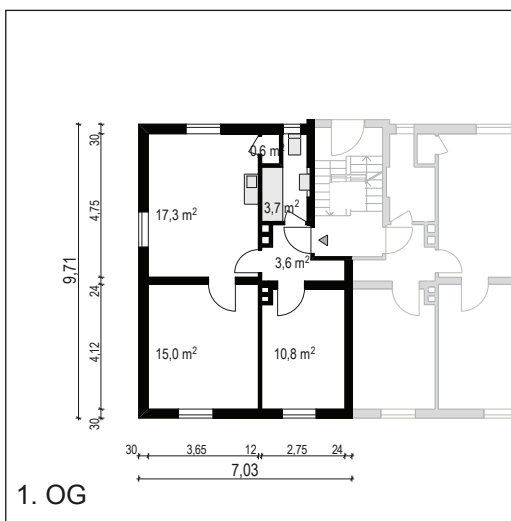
Beispielgrundriss Weiden, Marienbader Straße 9
